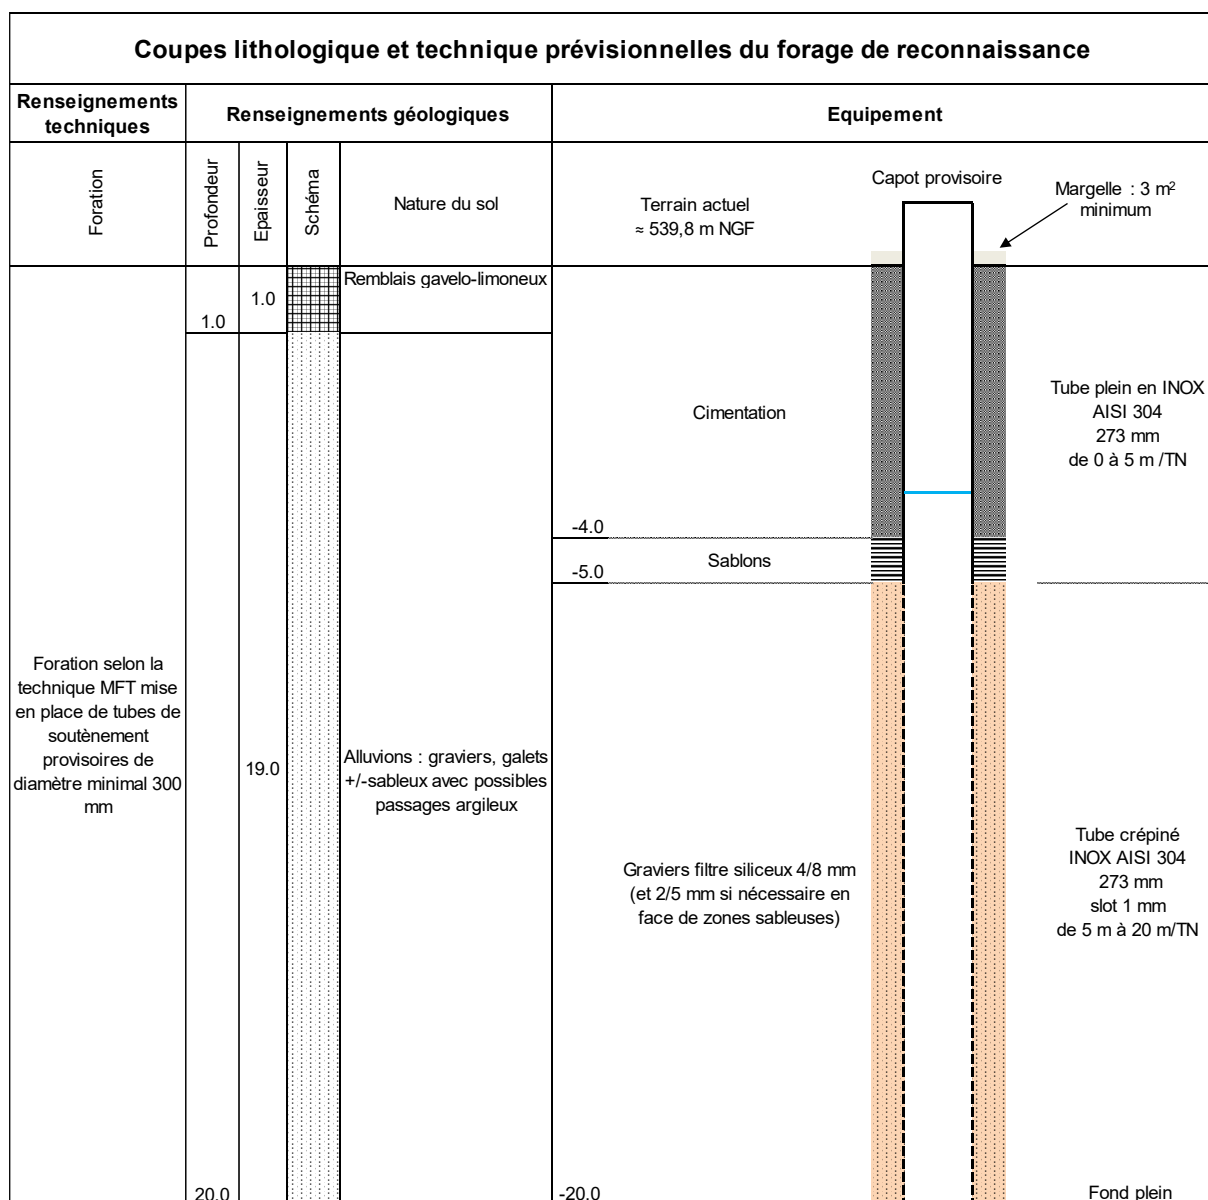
Coupe prévisionnelle du forage de reconnaissance proposé
